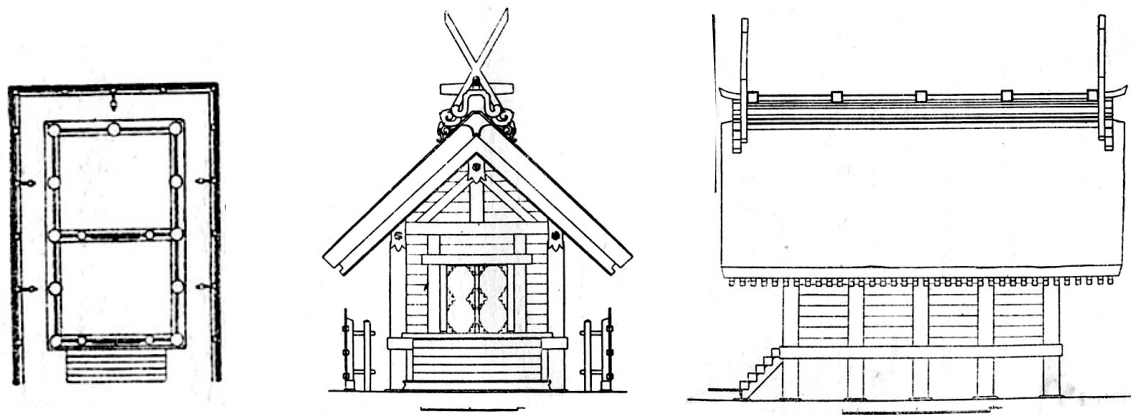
De izquierda a derecha: planta, alzado frontal y alzado lateral de un *honden* de estilo *sumiyoshi*.
